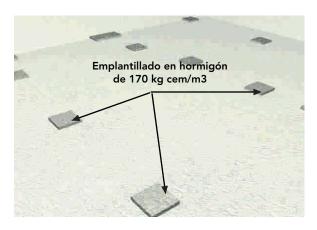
38: Vista del corte ejecutado a nivel del emplantillado de la fundación aislada de hormigón.
